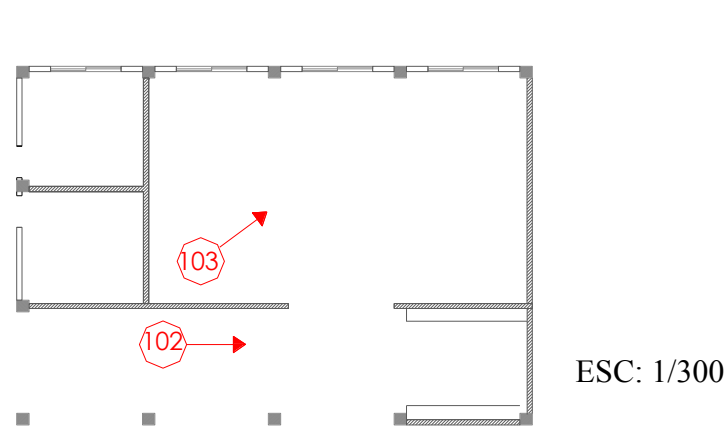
Planta Subterránea 1: Ubicación vista de fotografía
